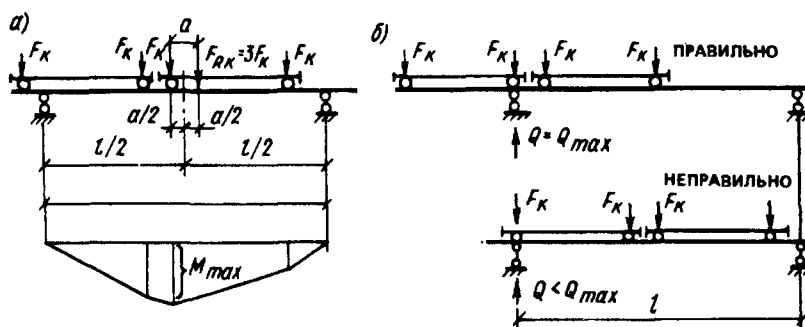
К определению расчетных усилий в разрезных подкрановых балках
